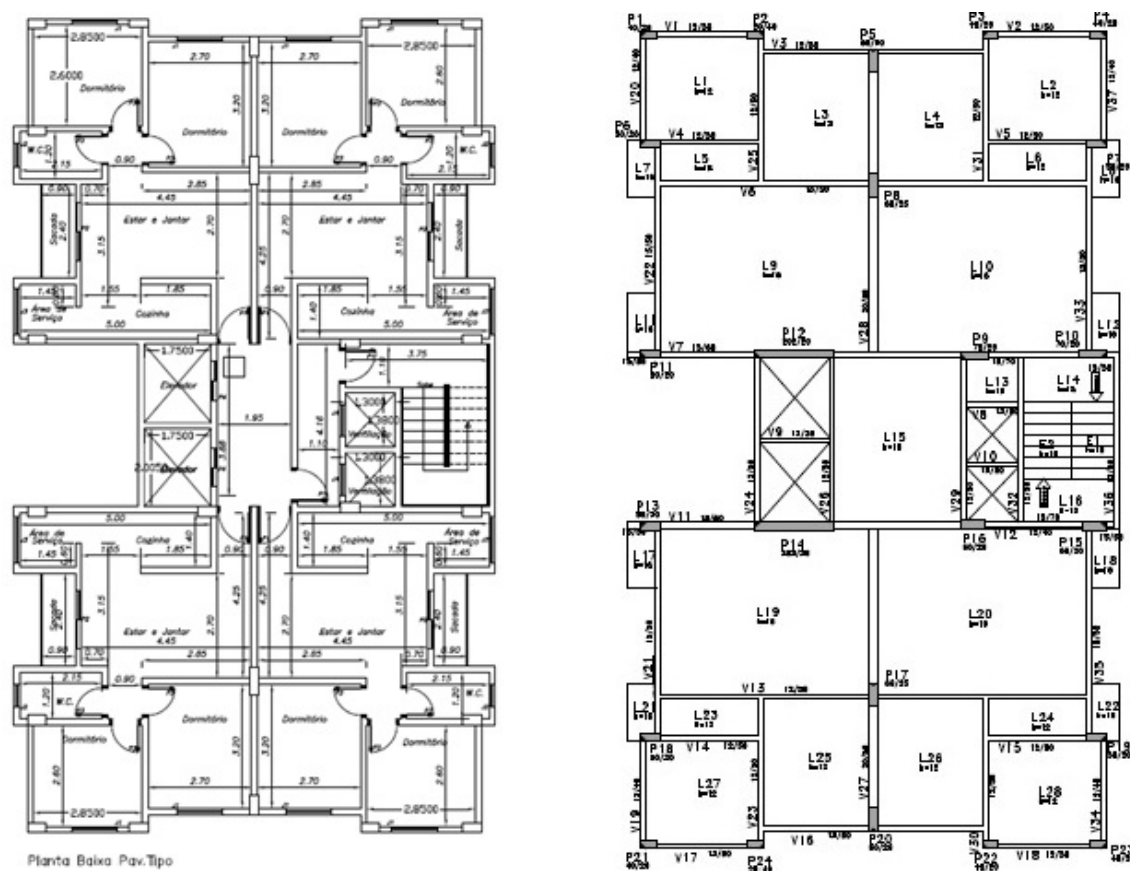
Planta de arquitetura e forma da estrutura do do pavimento Tipo do edifício em análise (s/escala)
